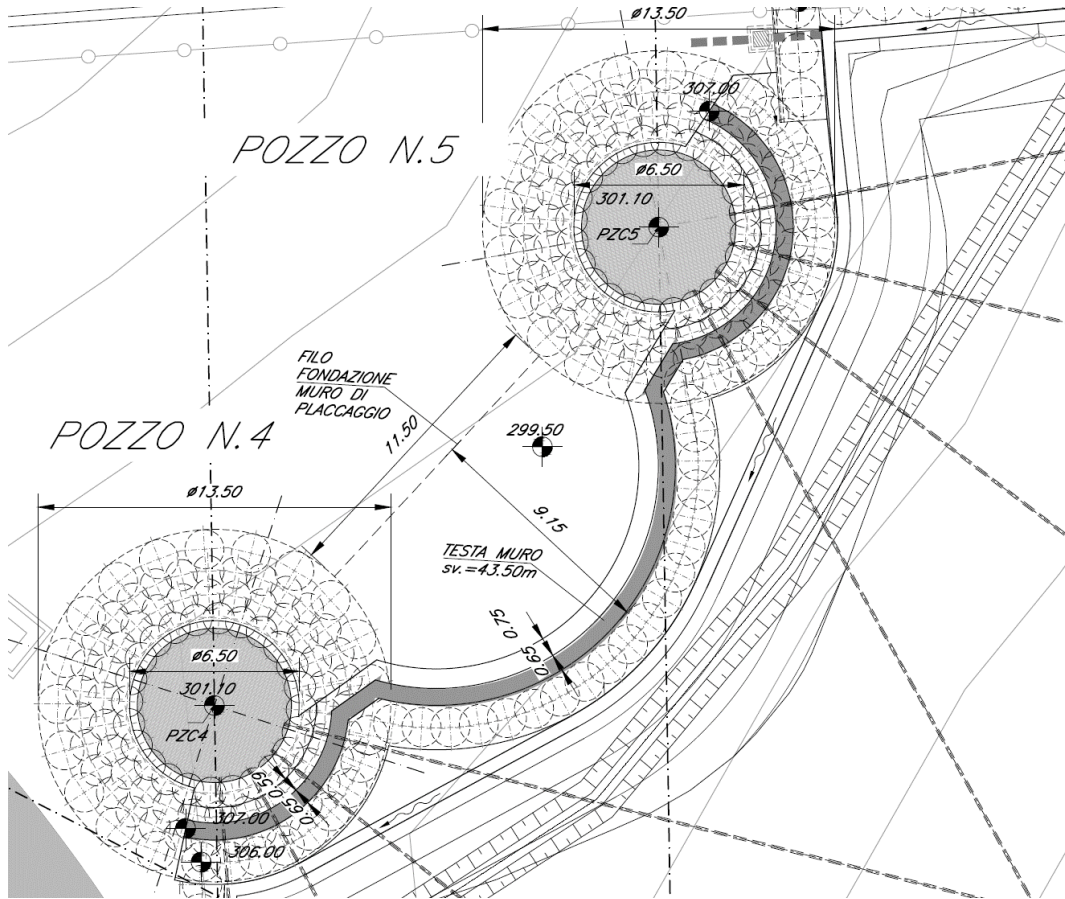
Planimetria muro di placcaggio definitivo Pozzi 4-5
